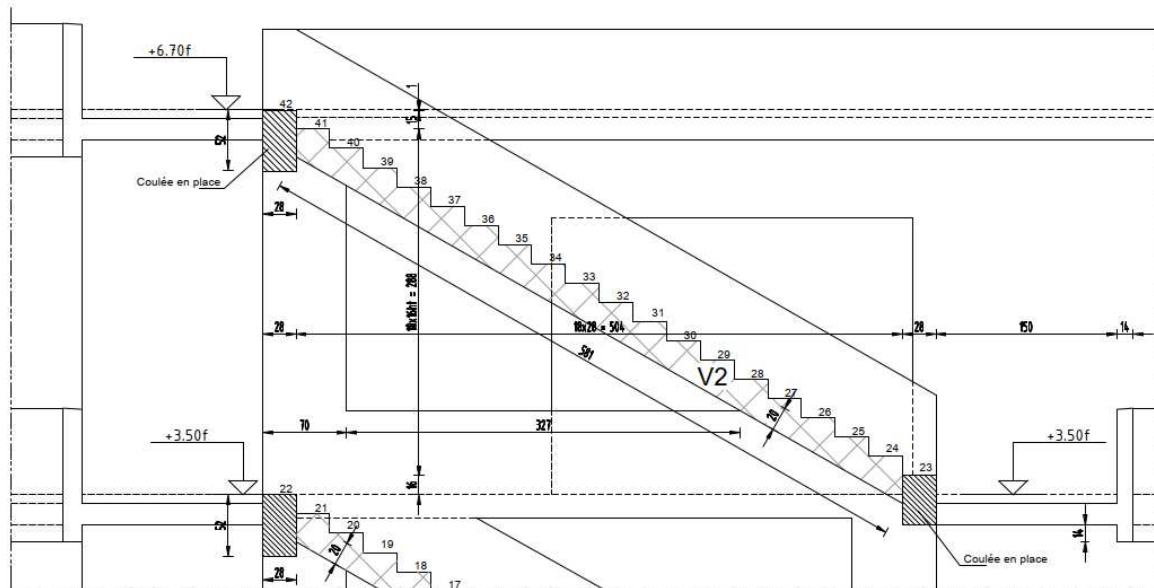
Vue en coupe sur l'escalier au niveau RDC
